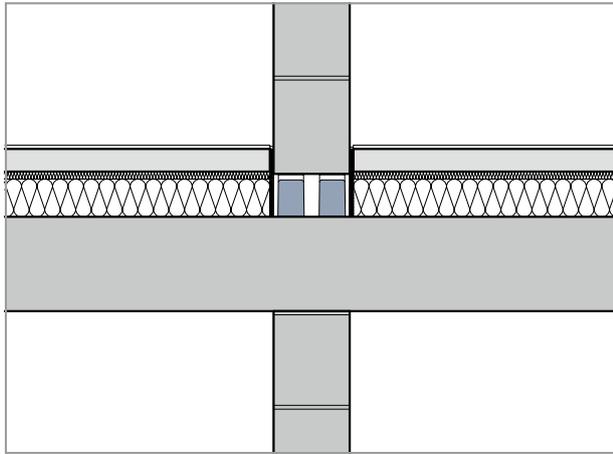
Schöck Sconnex® type M in masonry with internal walls and under-slab insulation
